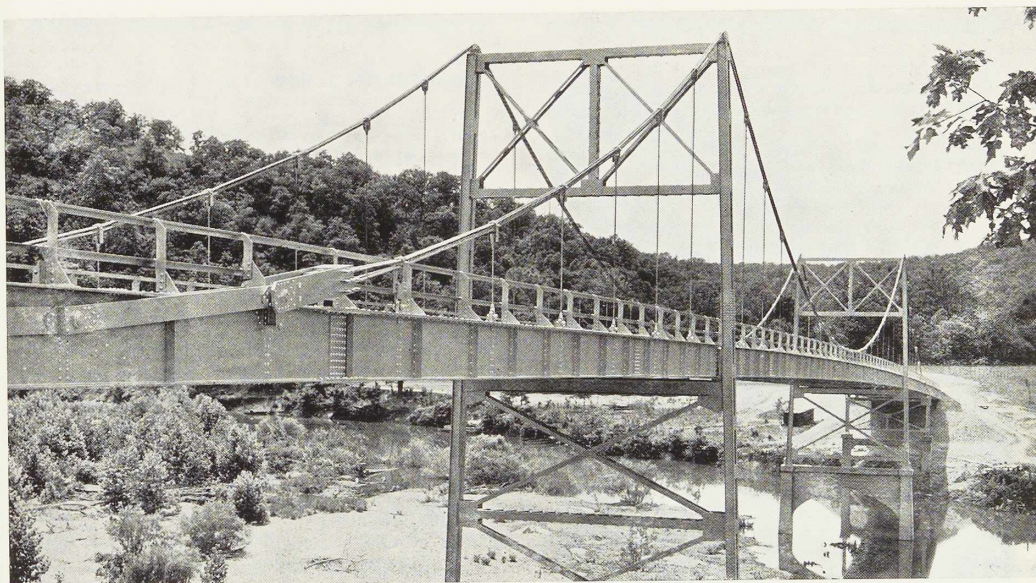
Vue générale du pont suspendu construit sur le lac d'Ozarks (Missouri).
